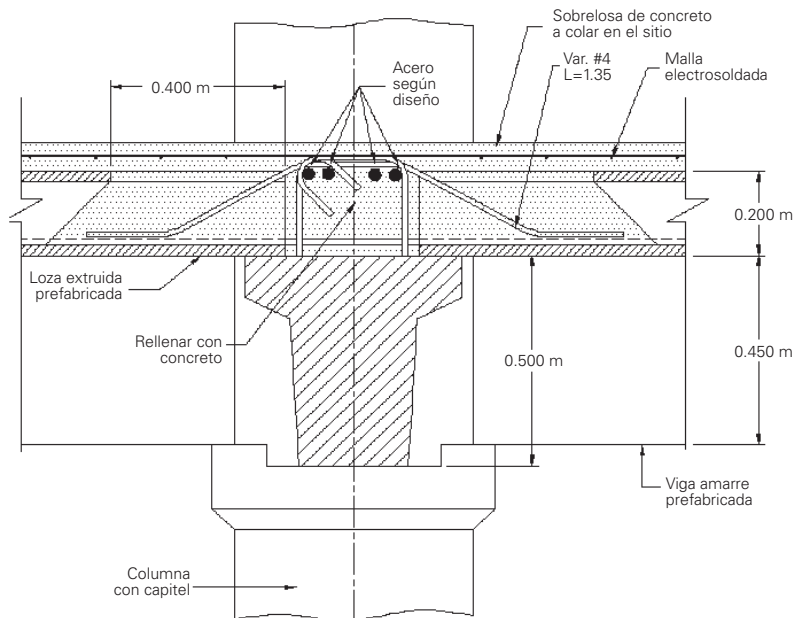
Llegada de losas huecas a vigas de soporte.
